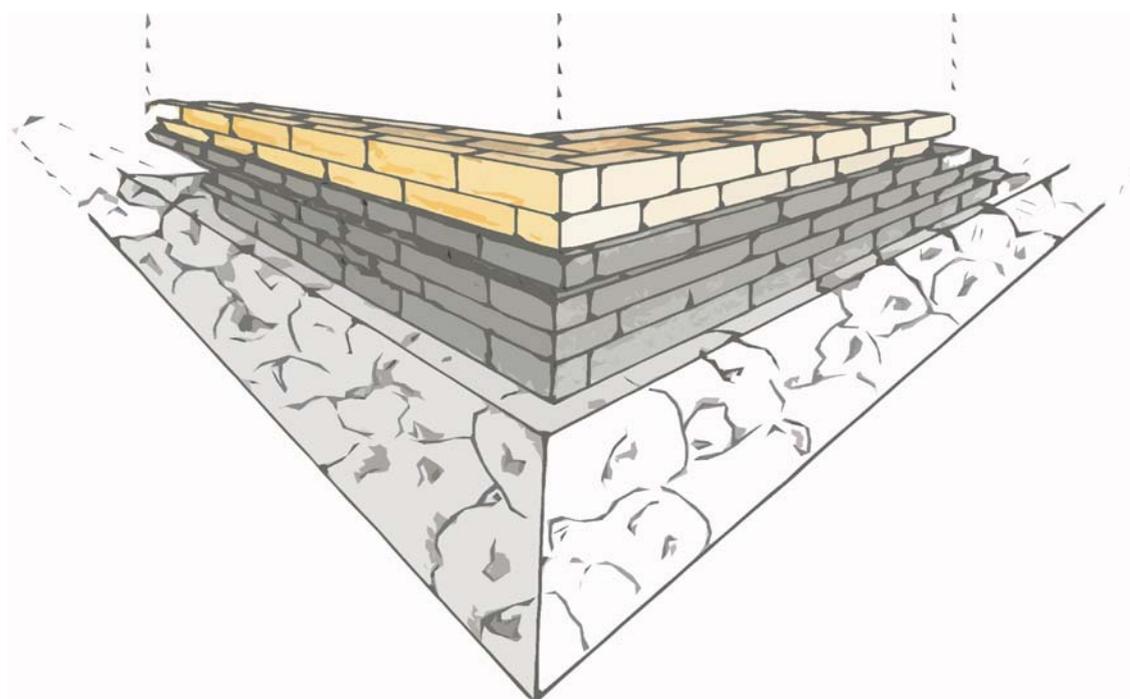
Detalle de cimentación. De abajo hacia arriba: Cimentación a base de zapatas corridas de piedra, desplante de rodapié de piedra de recinto y arranque de muro de ladrillo. Dibujo realizado por el autor. Ver Anexo 1. Cortes por fachada.
